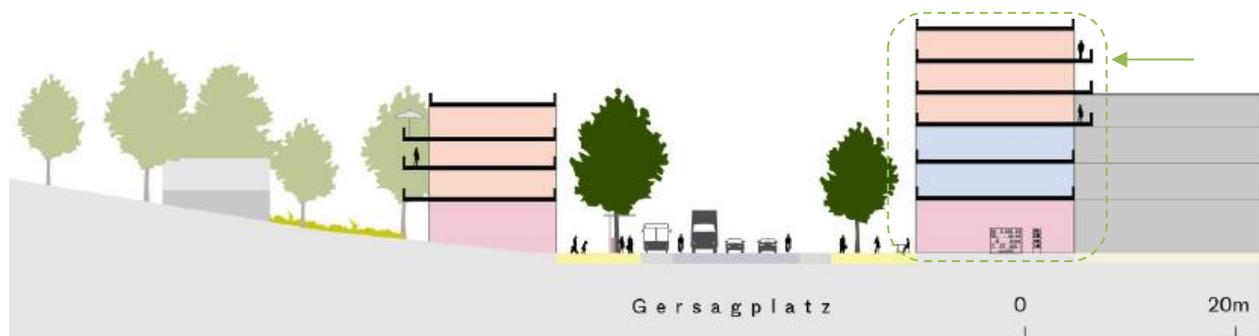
; Schnitt aus Studie Van de Wetering, Zürich, mit möglichem Neubau bei Bushub
